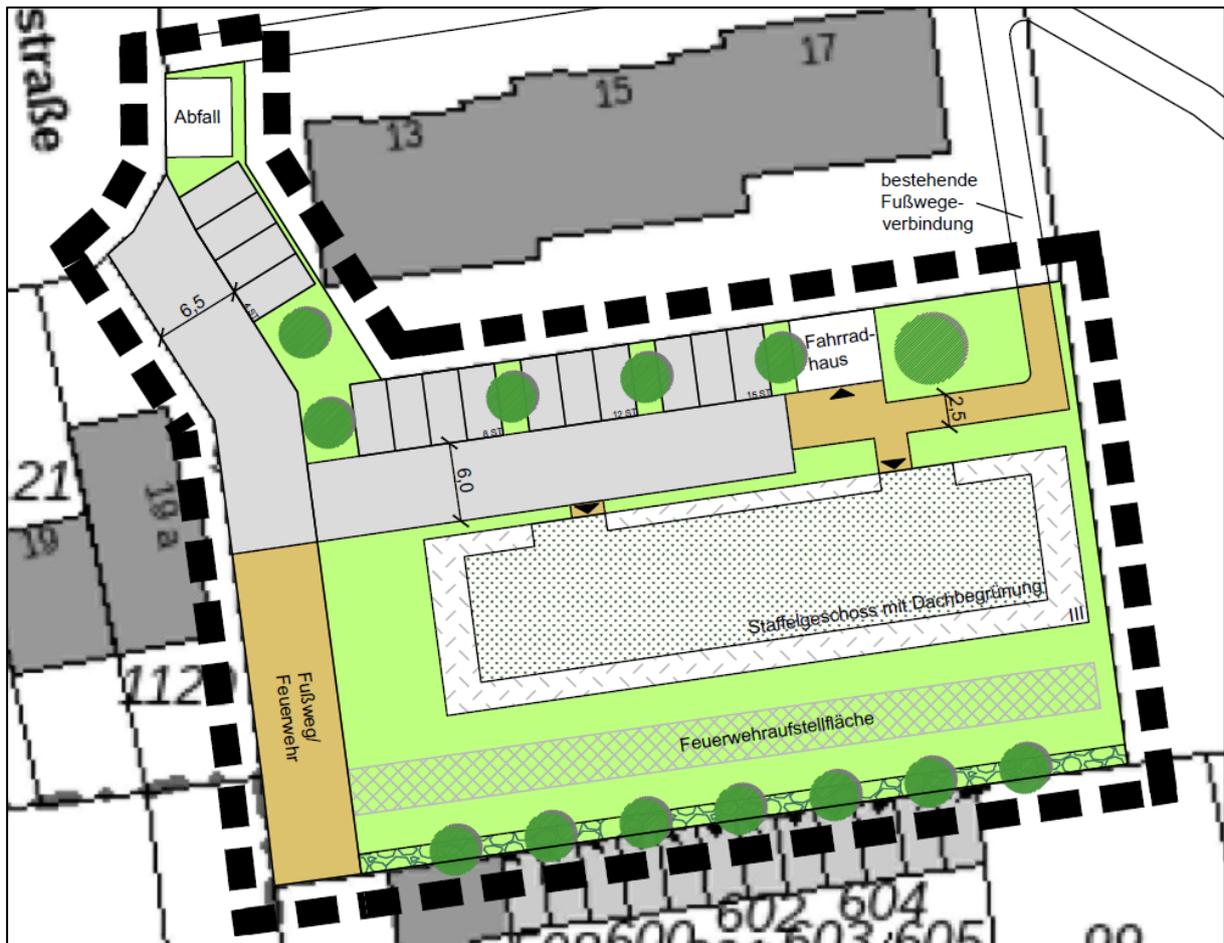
Städtebaulicher Entwurf des Bebauungsplans T 31, 13. Änderung in der Stadt Troisdorf (H + B STADTPLANUNG, Stand 17.08.2021). Unmaßstäbliche Darstellung
